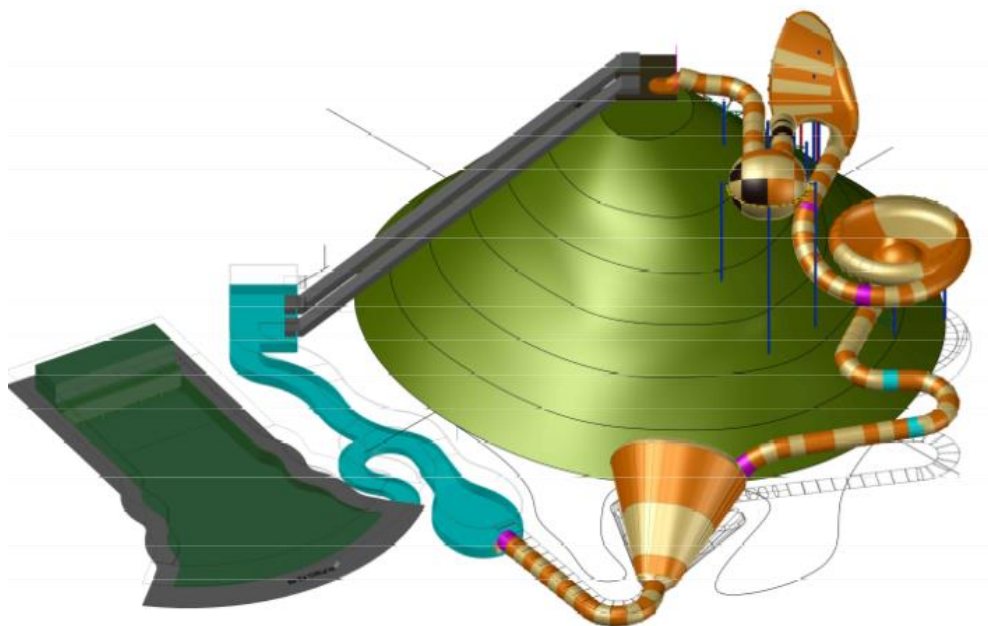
Vista 3d de las obras (vista lateral de las bandas transportadoras).
